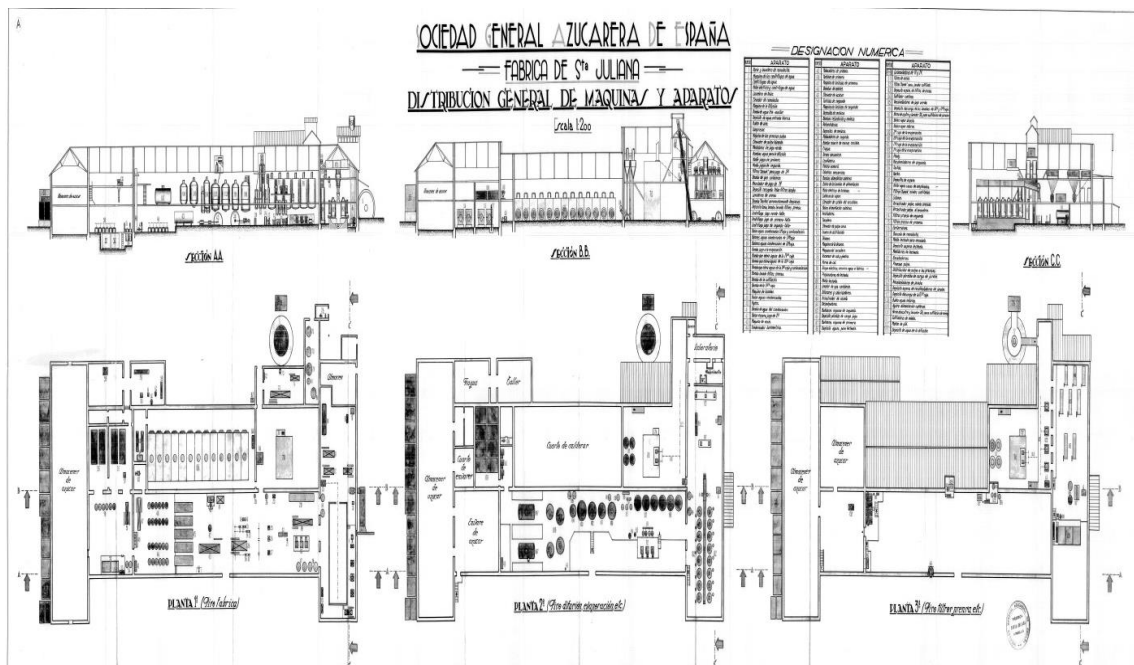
Plano general de la planta de la azucarera de Santa Juliana (Armillá). Fuente: ASGAE. Benavente
